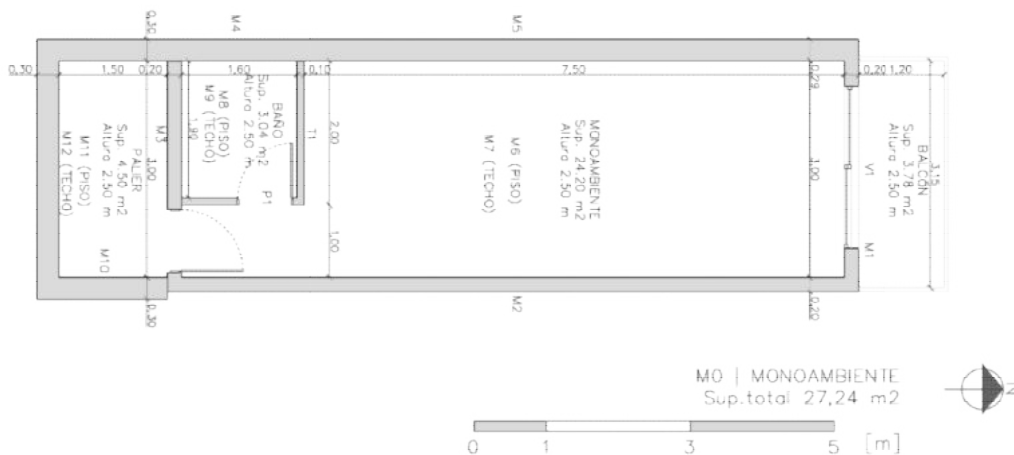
Esquema de planta del módulo M0. Fuente: Elaboración propia del equipo.
